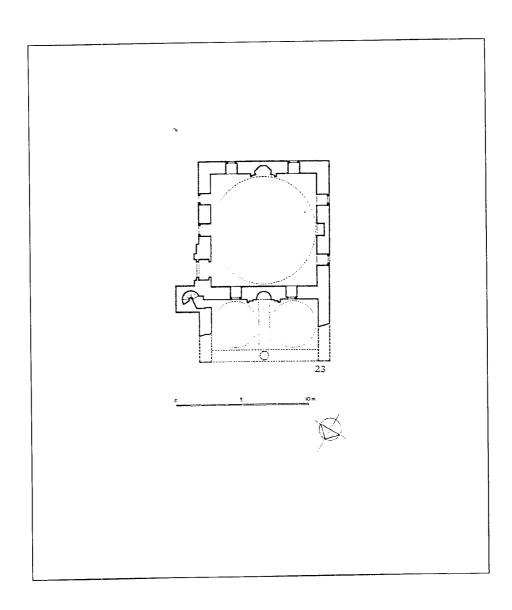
مسقط أفقي لمسجد خداوندكار في توزلا (عن : أيفردى) .
